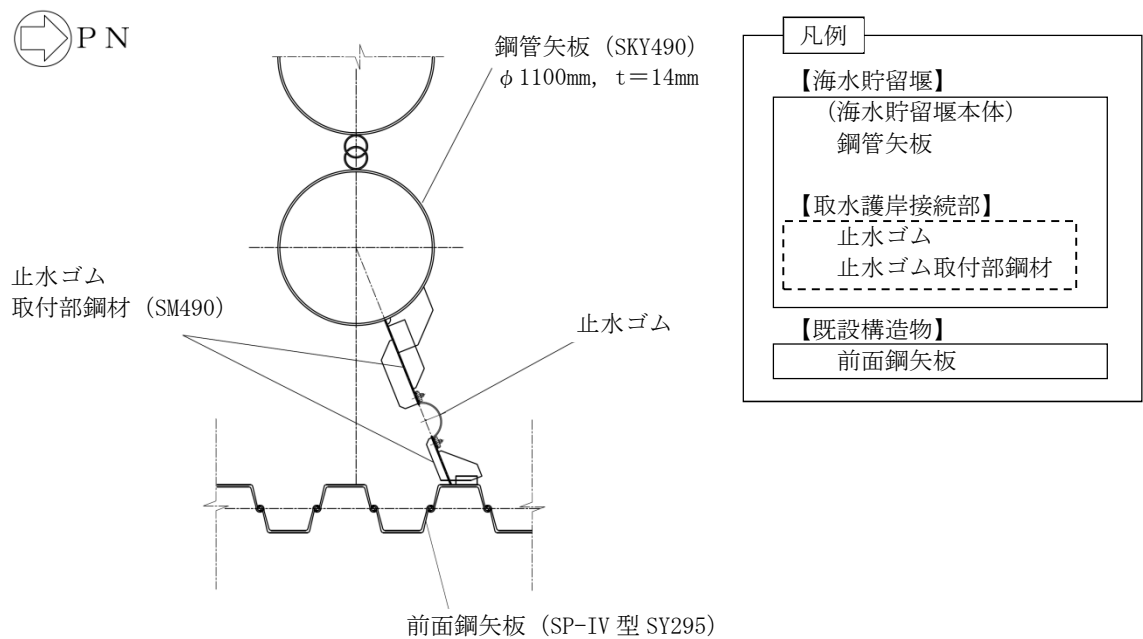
(2) 取水護岸の平面図 (A部拡大)
